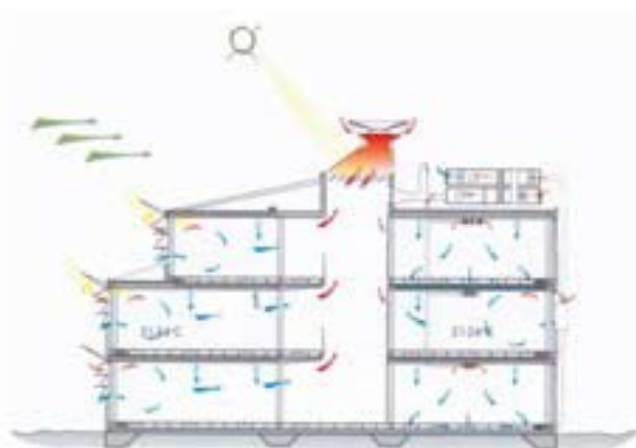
Bâtiment avec structure en acier et plancher conventionnels permettant une stratégie de ventilation naturelle
